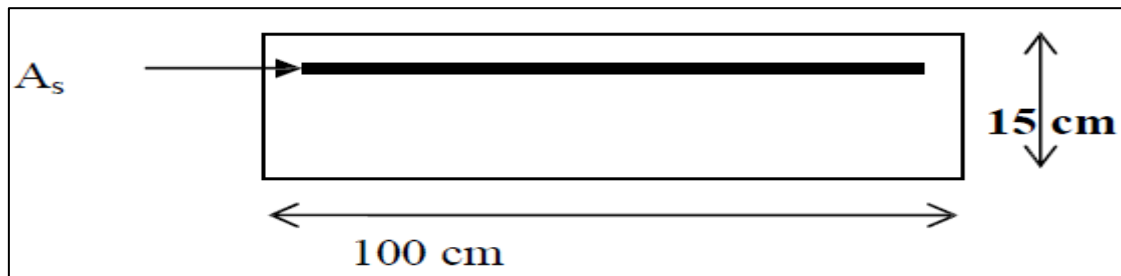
Coupe transversale d'un mètre linéaire du balcon
